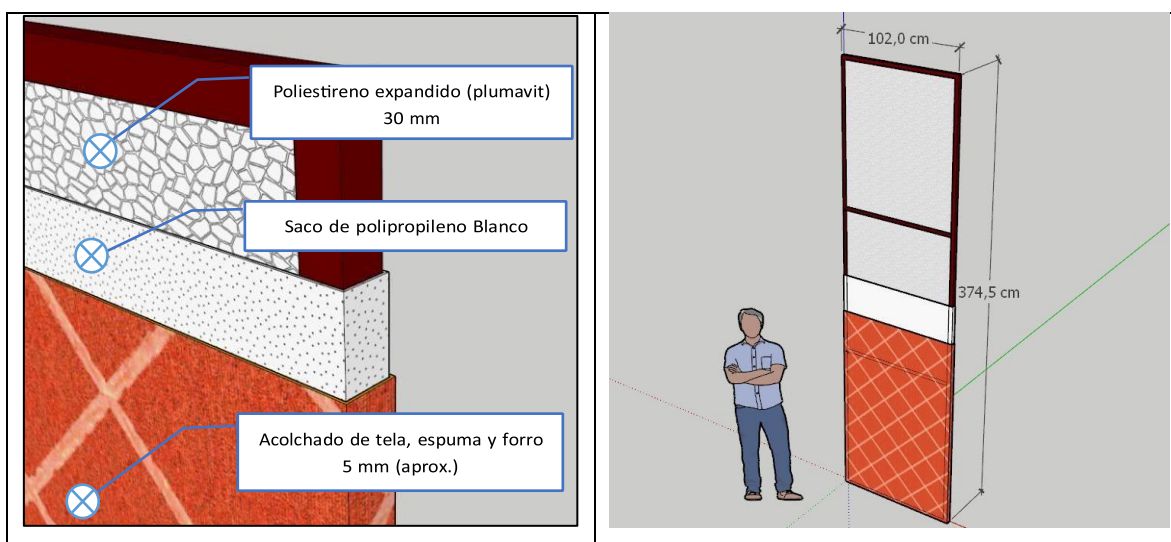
Detalle de materialidad de barreras actuales en terraza del salón Tarapacá.
